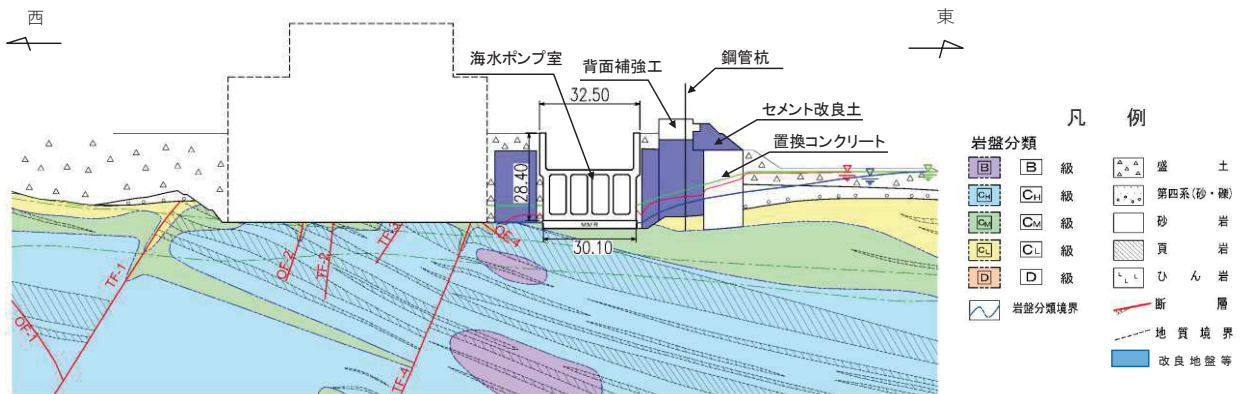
鋼管式鉛直壁（一般部）と隣接する構造物位置の断面図（第2号機海水ポンプ室）
